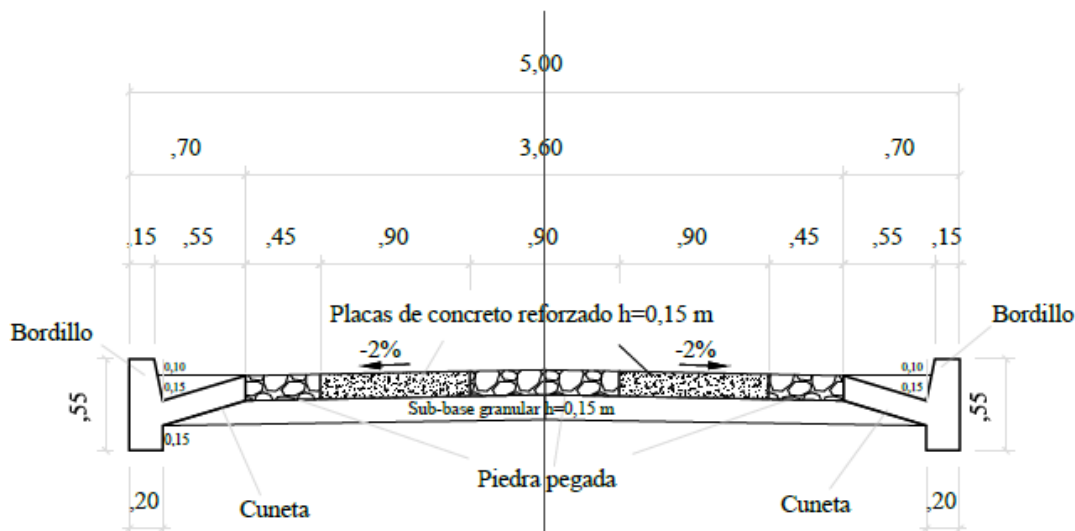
Detalle de la sección transversal en tangente de la placa huella
